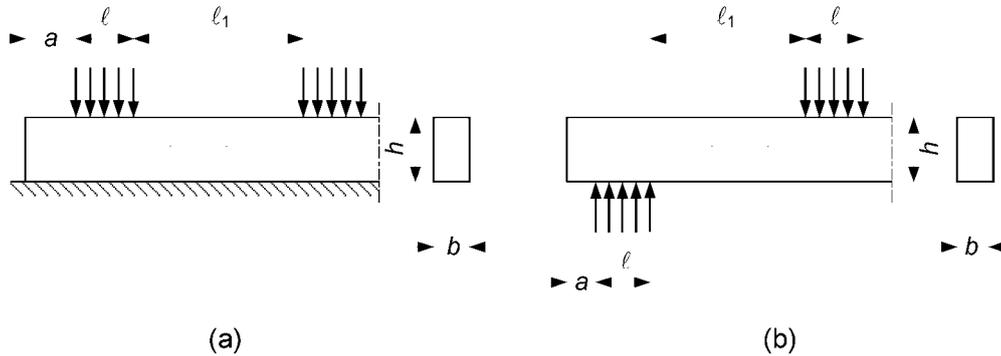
Bauteil auf (a) kontinuierlicher Lagerung und (b) Einzellagerung
